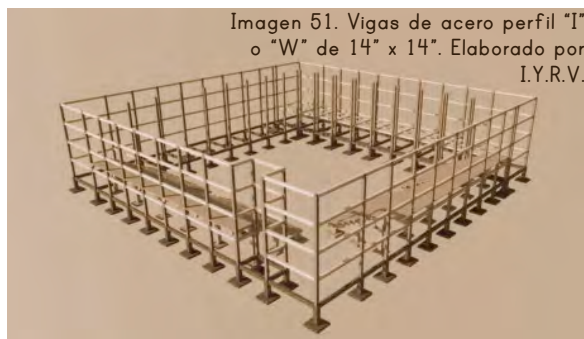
Vigas de acero perfil "I" o "W" de 14" x 14". Elaborado por I.Y.R.V.
